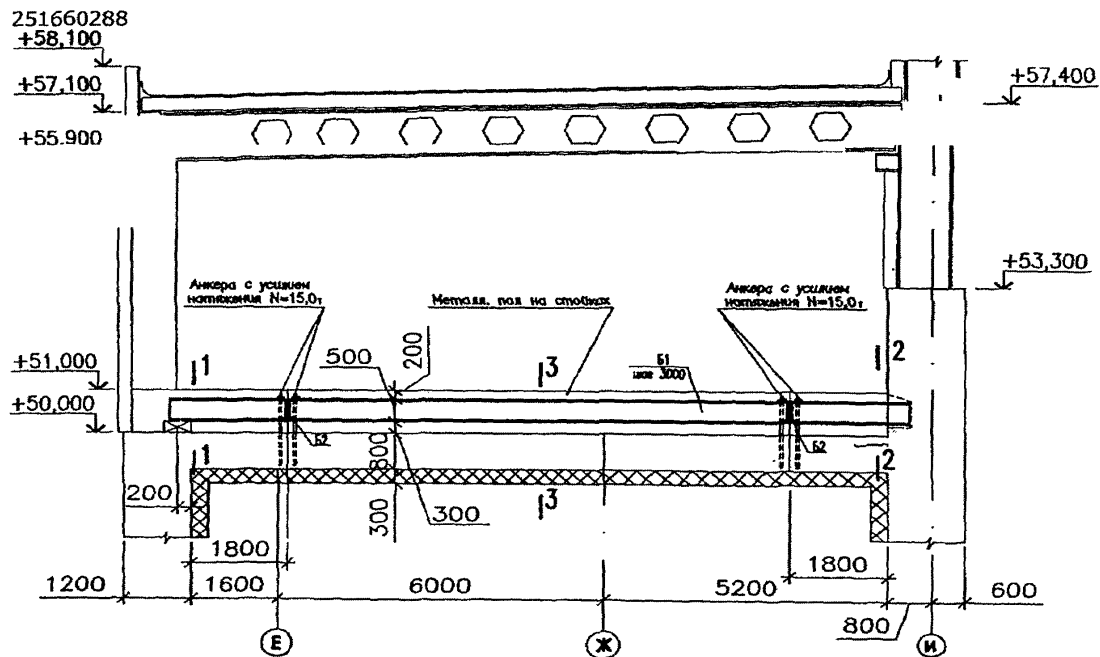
Способ усиления перекрытия с помощью анкеров
